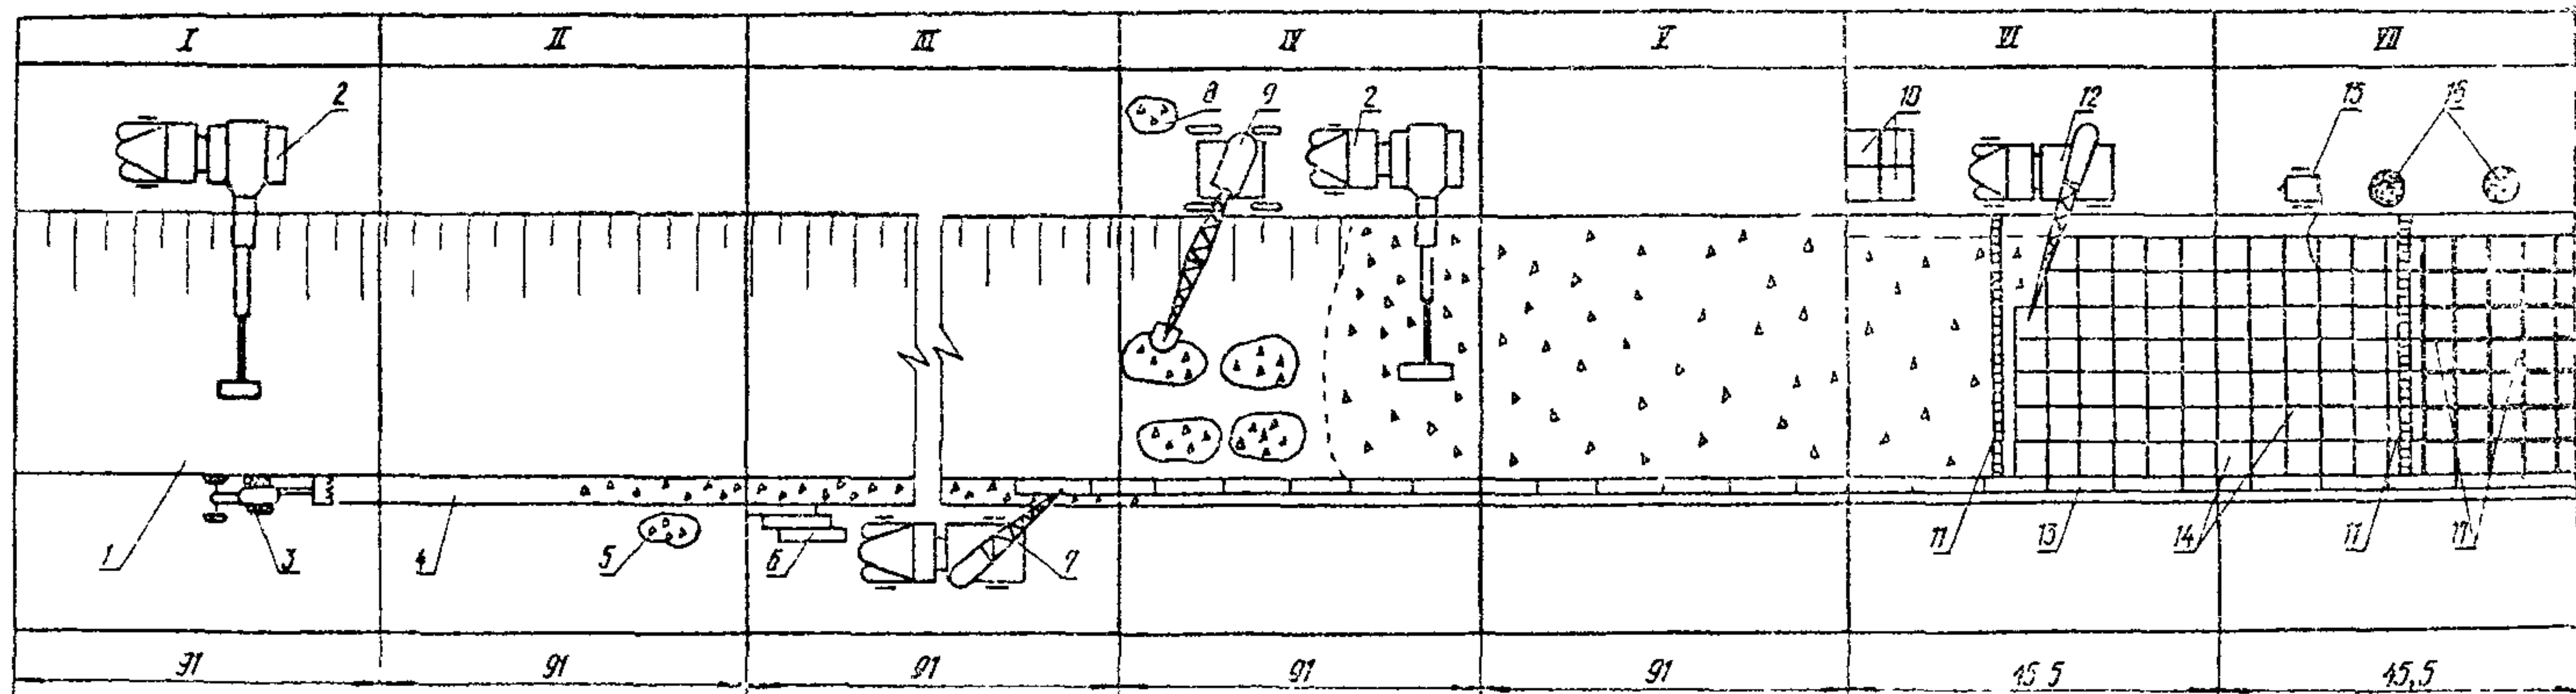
Технологическая последовательность выполнения комплекса работ по укреплению откоса насыпи железобетонными плитами:
